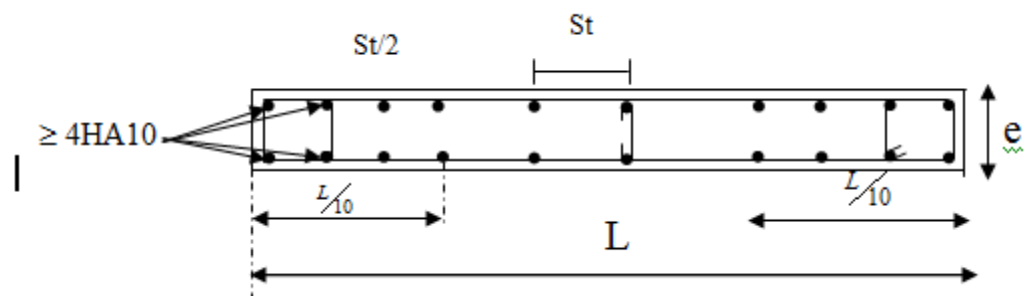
Disposition des armatures verticales dans les voiles.
